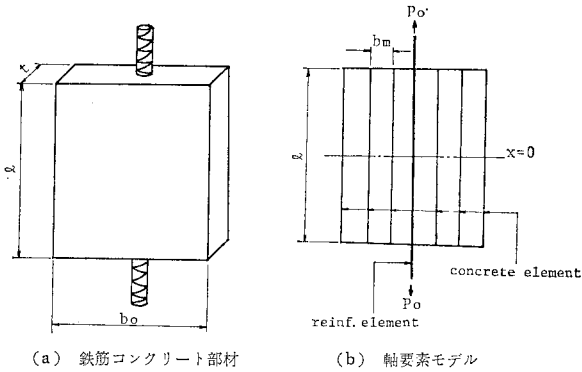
対称な鉄筋コンクリート部材とその軸要素モデル
